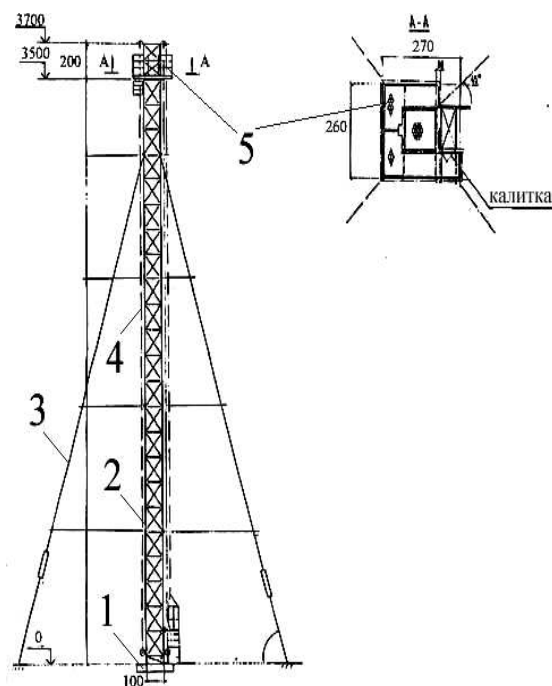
Вышка пожарная наблюдательная ВПН: 1 – фундамент; 2 – фермовый ствол; 3 – растяжка; 4 – канат ручной лебедки; 5 – площадка для наблюдения; 6 – направляющая для подъемника; 7 – подъемник
